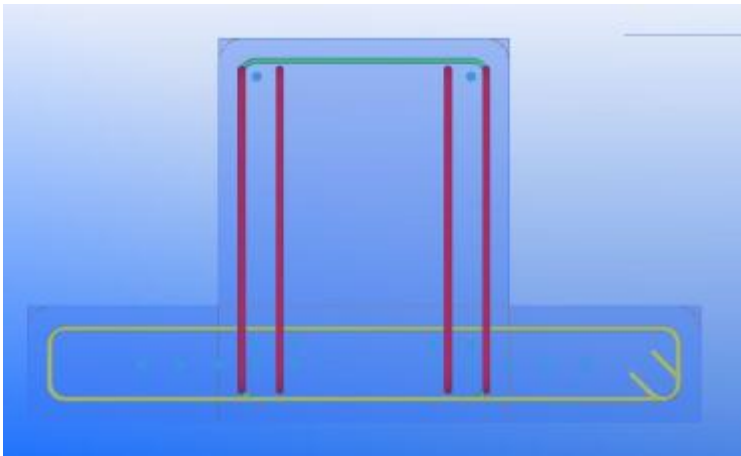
Inverted tee beam- automated reinforcement layout (52)* -kuvake
